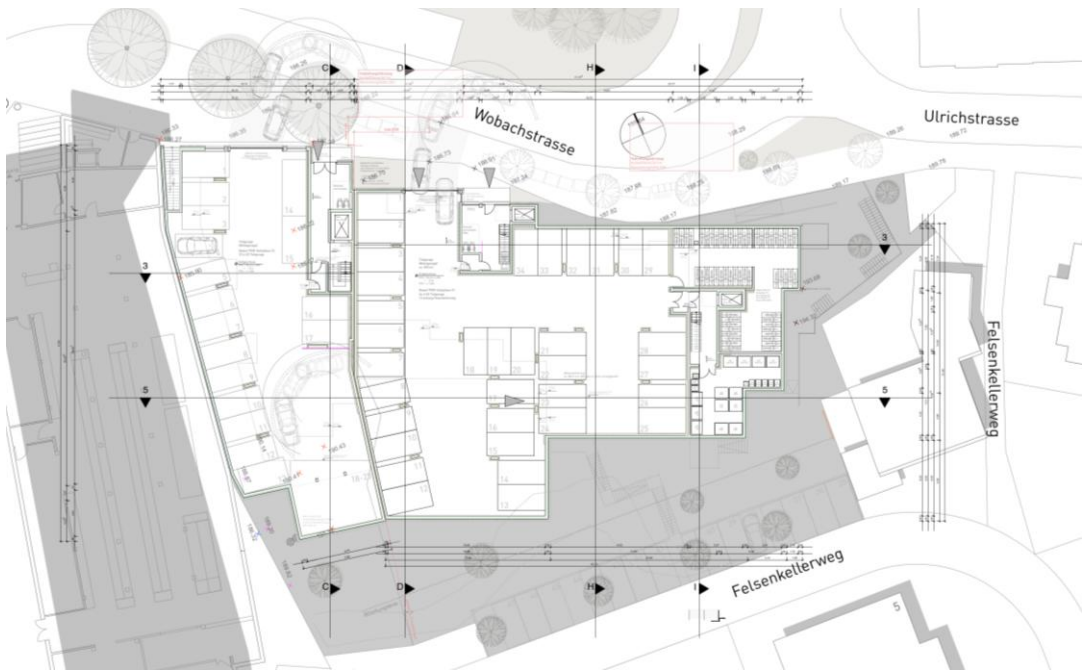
Erdgeschoss (Tiefgaragen), L/A LIEBEL/Architekten BDA, Stand 06.10.2025
